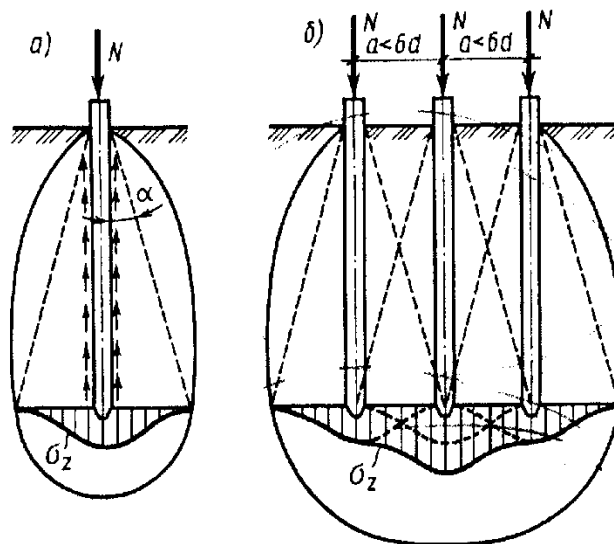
Схемы передачи нагрузки на грунт основания:
